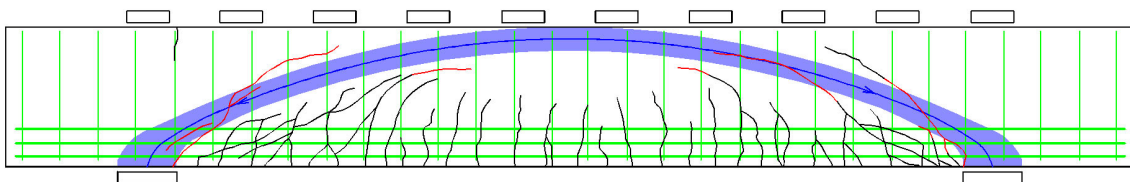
Balken C 4 mit überlagerter Druckparabel und zugehörigen Rissen
